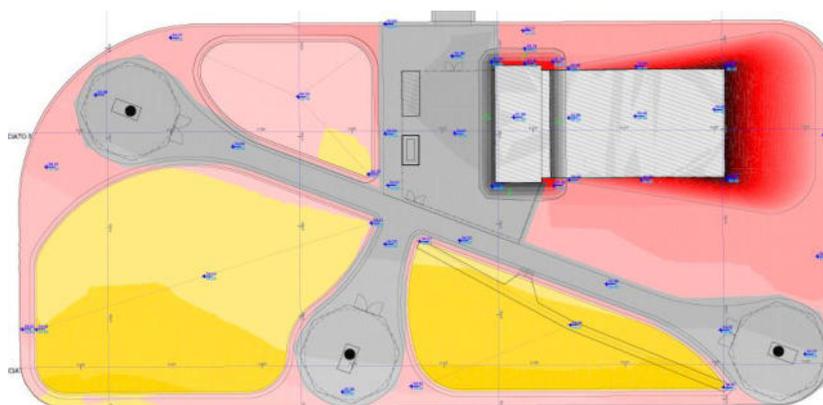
Planimetria fase 2 movimenti terra con indicazione in giallo delle aree soggette a scavo per realizzazione depressioni terreno, e in rosso i rinterri e rilevati.
